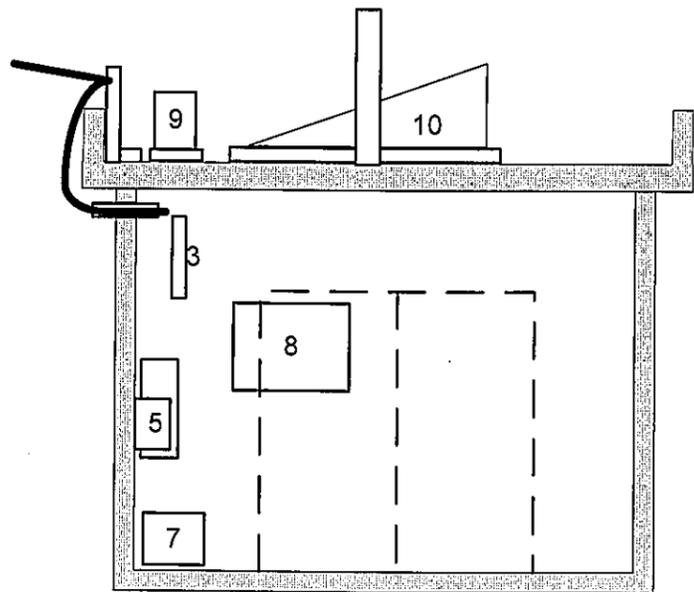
PLAN D'AMENAGEMENT DES EQUIPEMENTS
